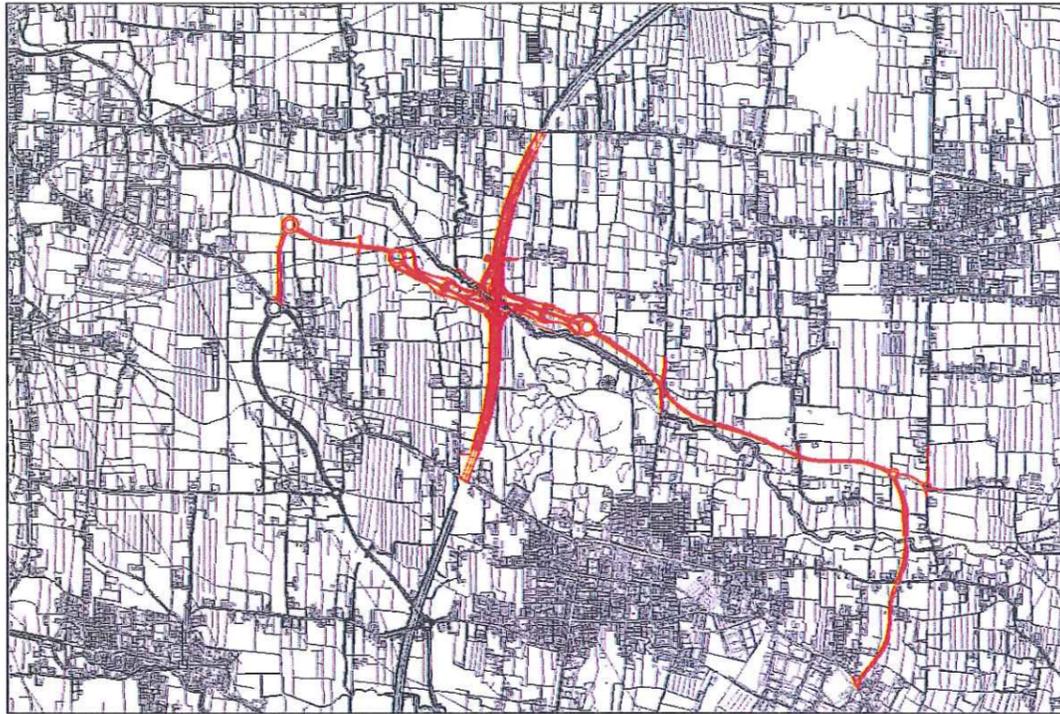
Planimetria di progetto inserita nelle simulazioni
